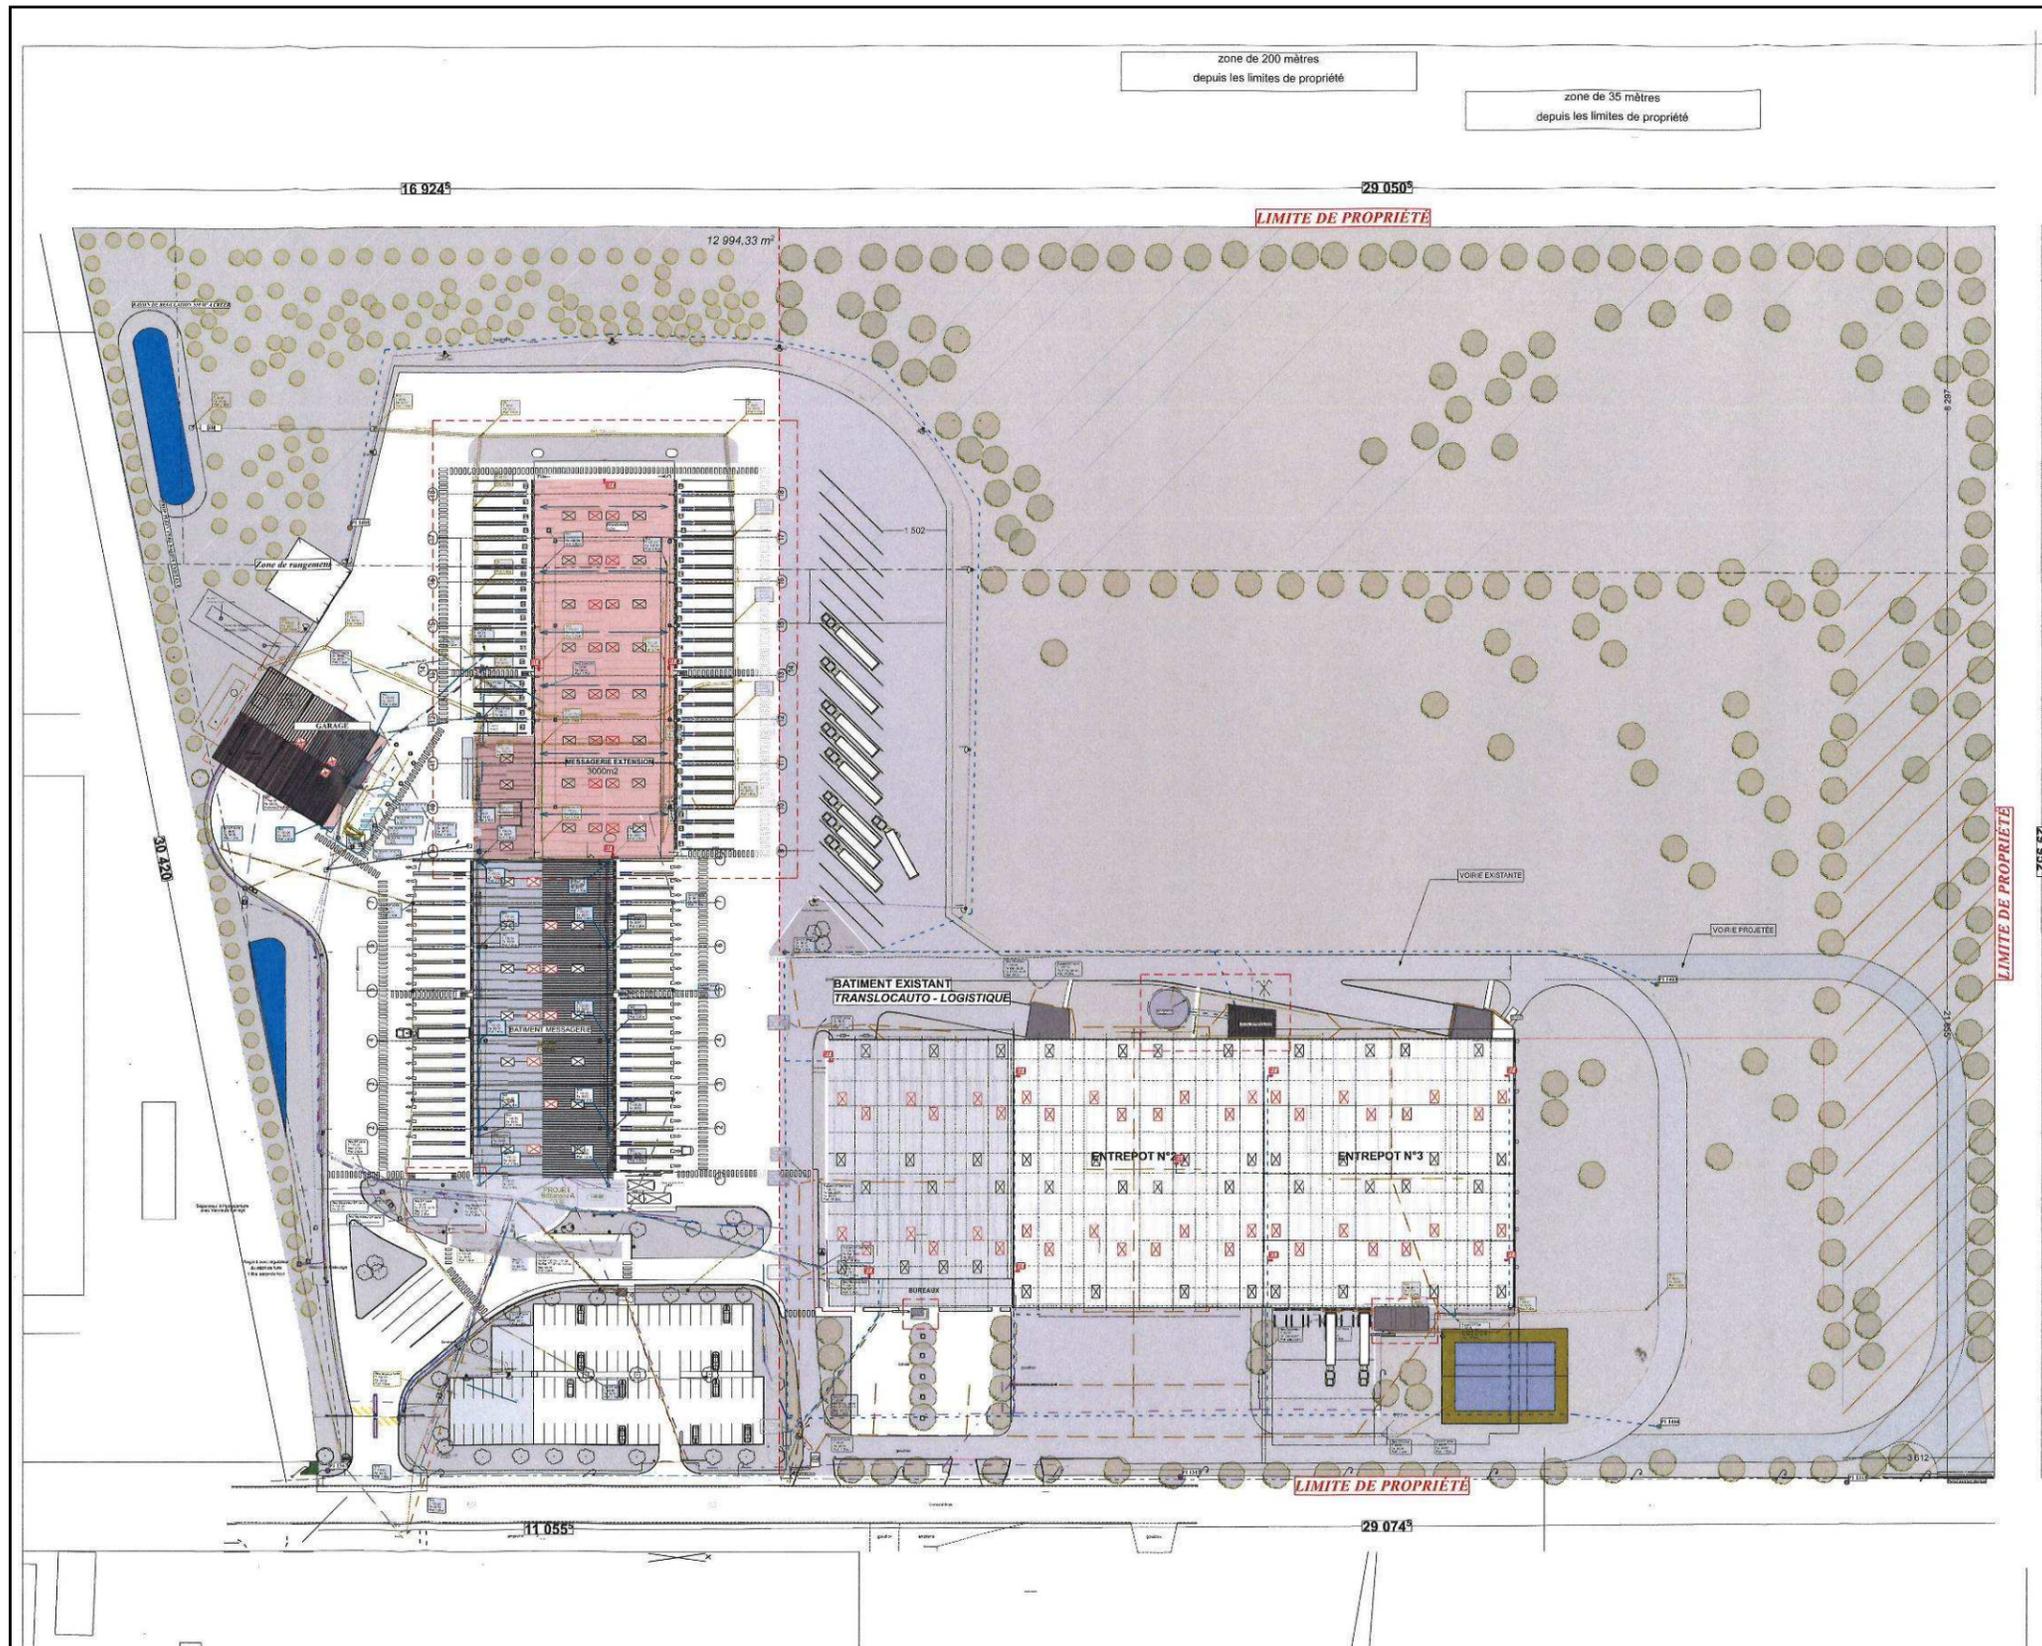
plan masse du site TRANSLOCAUTO (avec projet d'extensions)
